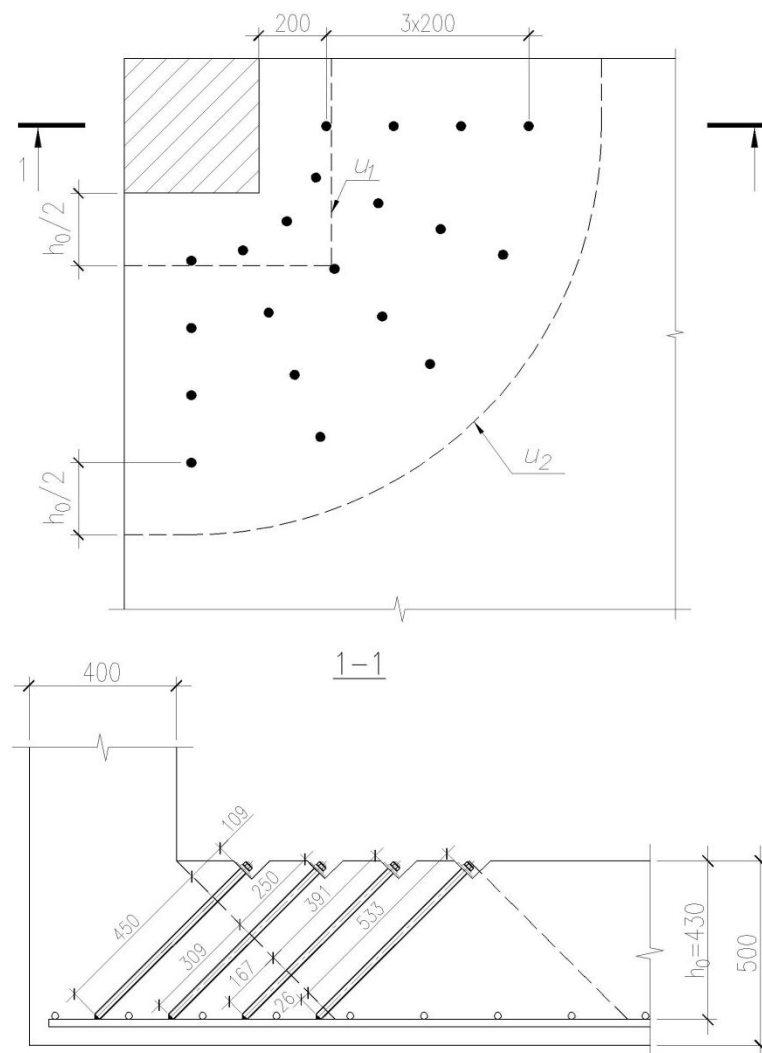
Схема усиления фундаментной плиты на продавливание.
